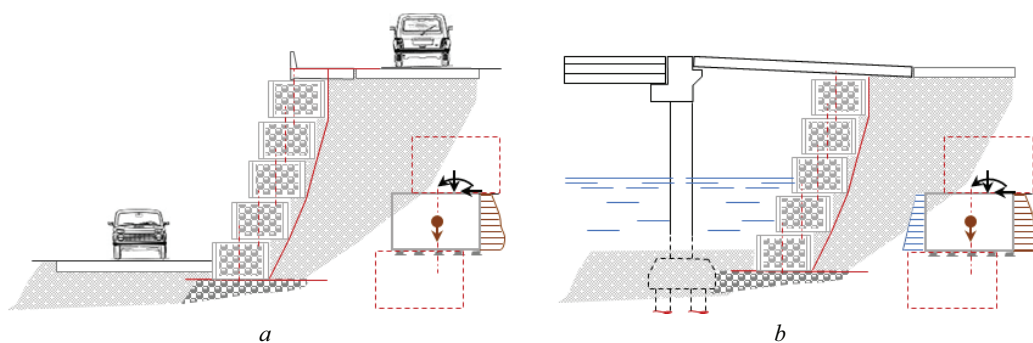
Схемы сечений и фрагменты расчетных схем подпорных сооружений из заполненных щебнем блоков в транспортном строительстве: а — подпорная стенка дорожной насыпи; б — устой мостового перехода
